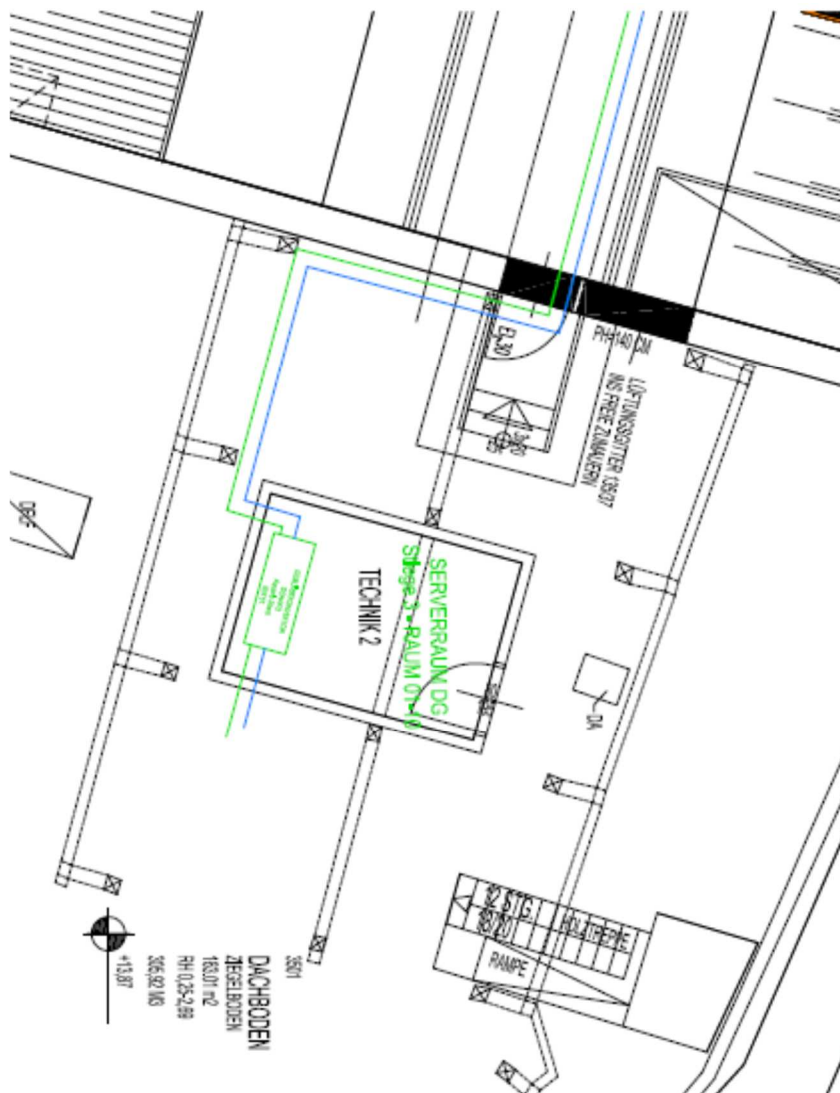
Grundrissausschnitt Dachgeschoss Serrraum 02-20
